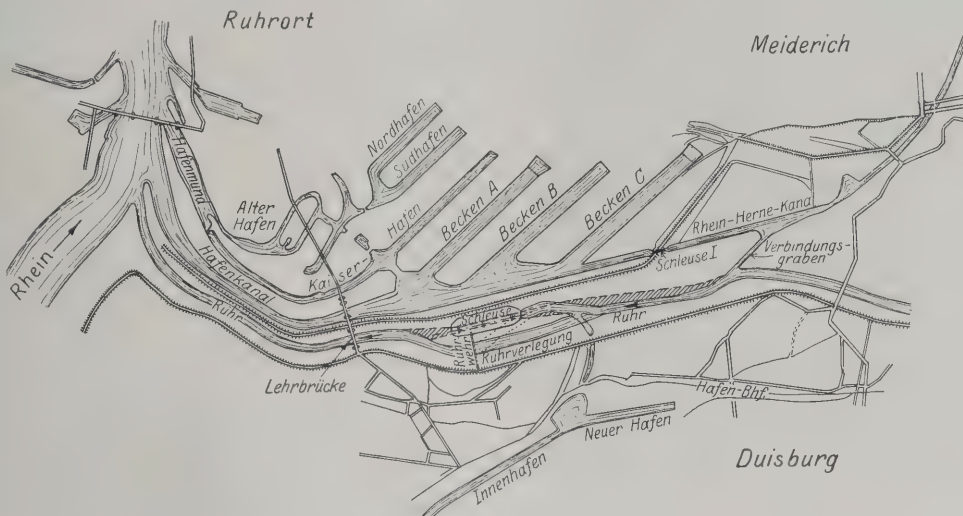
Übersichtsplan mit Schleusenbaustelle.
